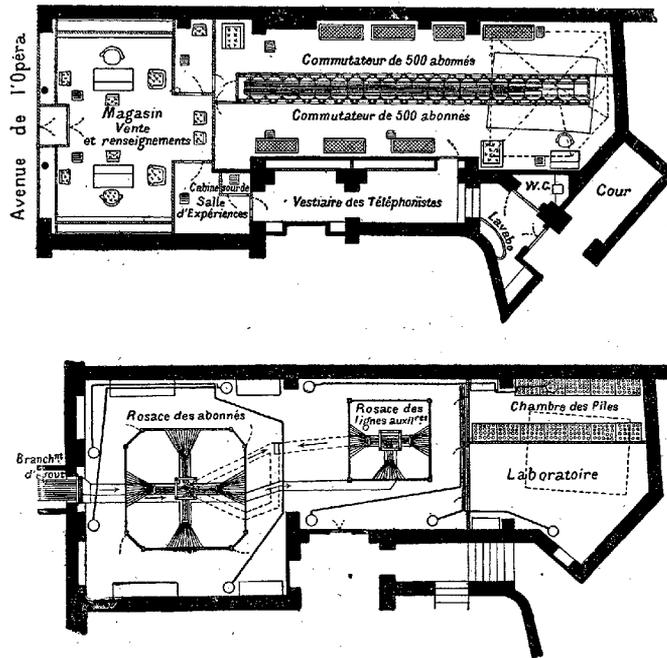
Plans du rez-de-chaussée et du sous-sol des bureaux.
